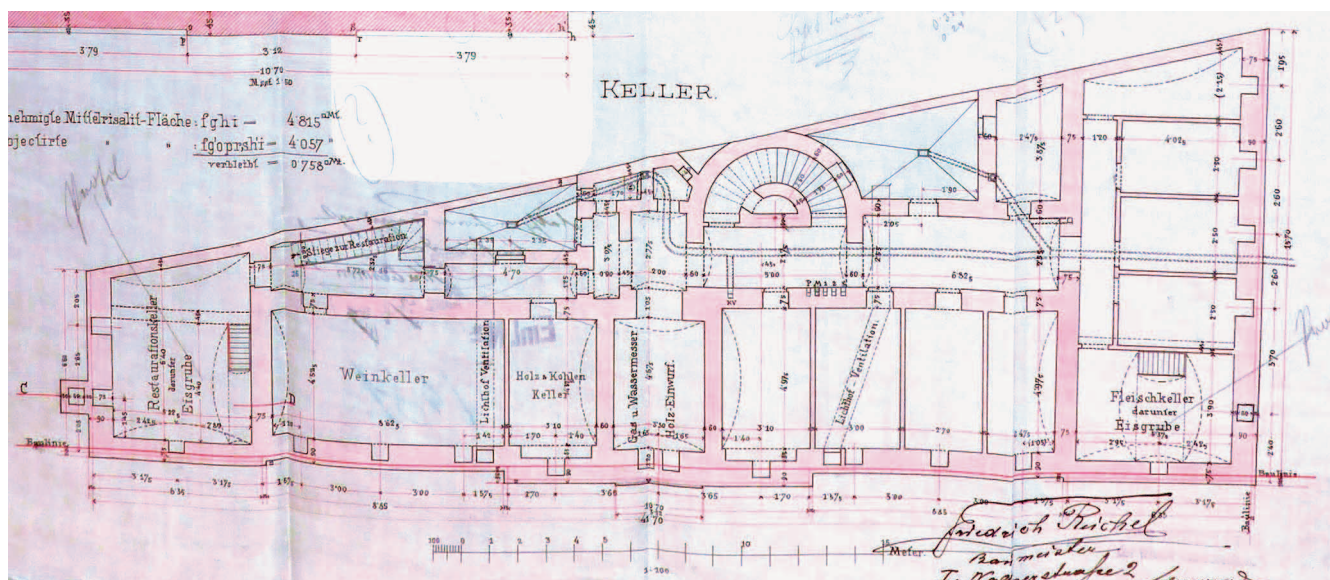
Kellerplan des Hauses Garelligasse 3/Frankgasse 7 vom 27. März 1889. (Plan: MA 37 – Baupolizei, Wien 9, EZ 1481)
